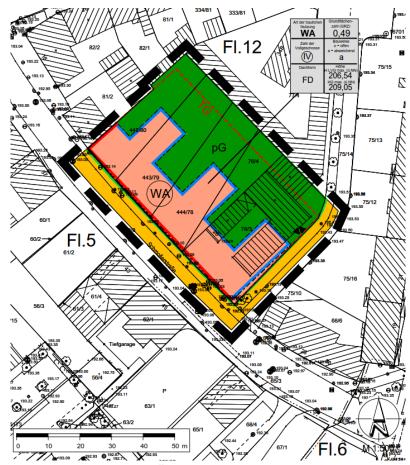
Entwurf Bebauungsplan "Änderung Bruchwiese II, Teilbereich Schmollerstraße"
